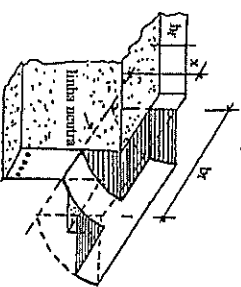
Distribuição ideal de tensões na zona comprimida das vigas de concreto com seção T
